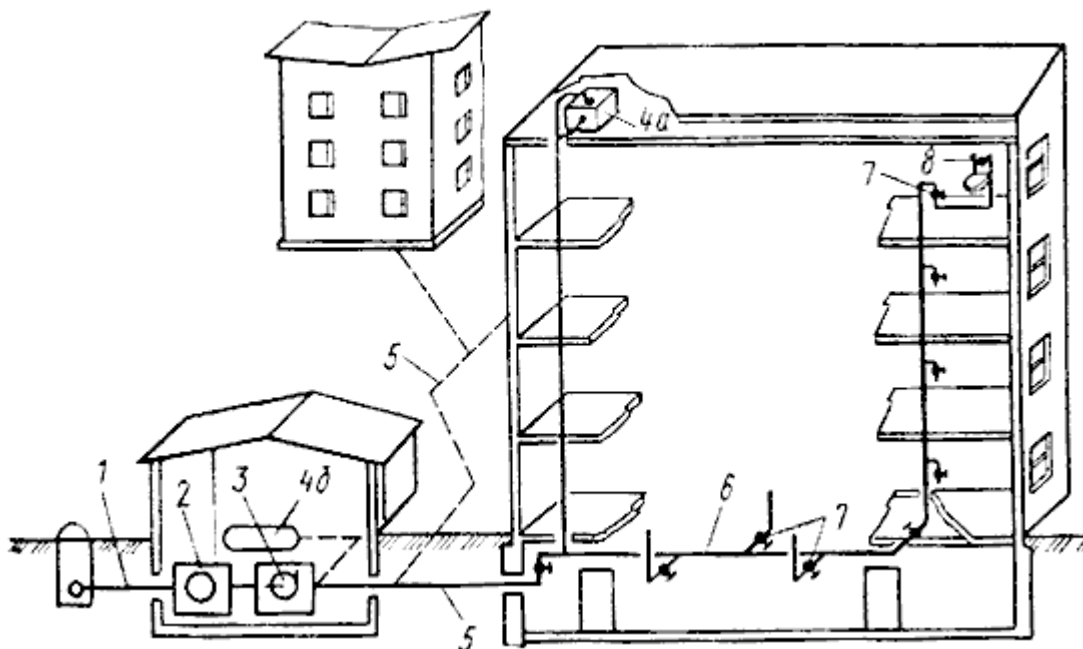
Элементы системы внутреннего (холодного) водопровода:
